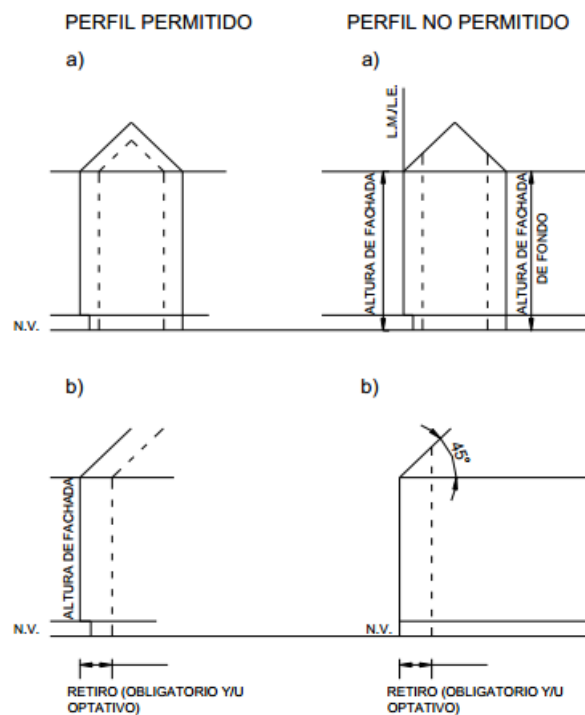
DISPOSICIONES DE FACHADA Y ALTURA LIBRE
